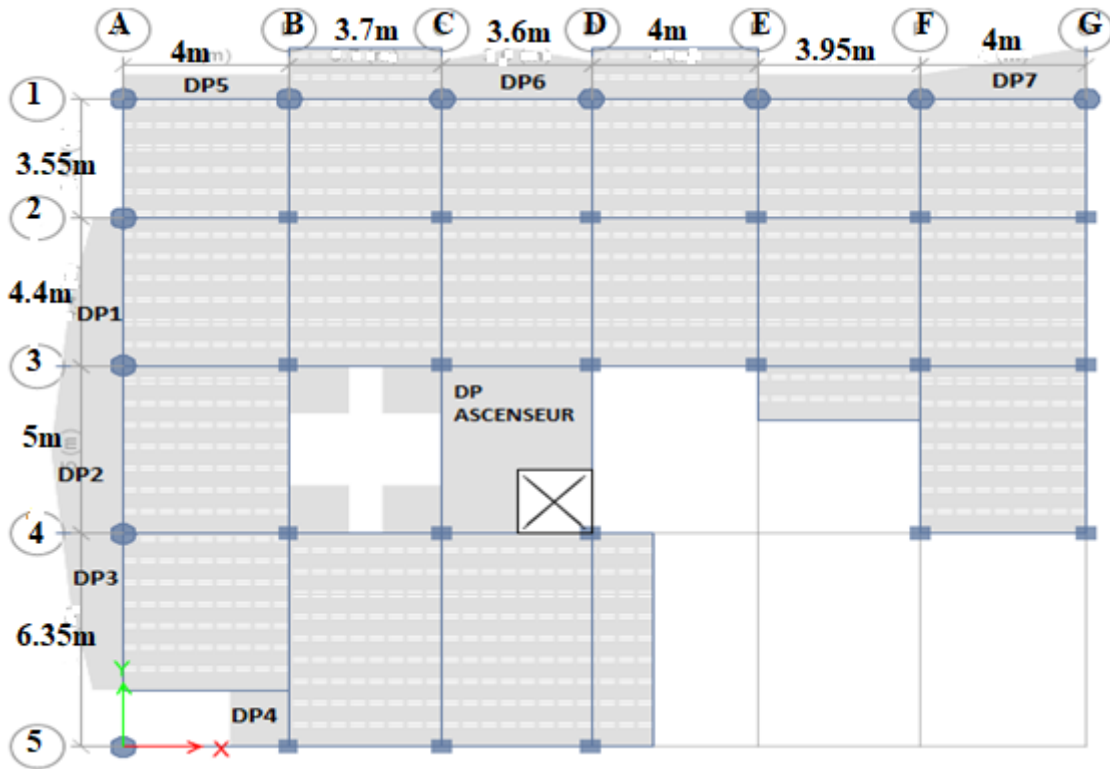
Disposition des poutrelles plancher étage courant
